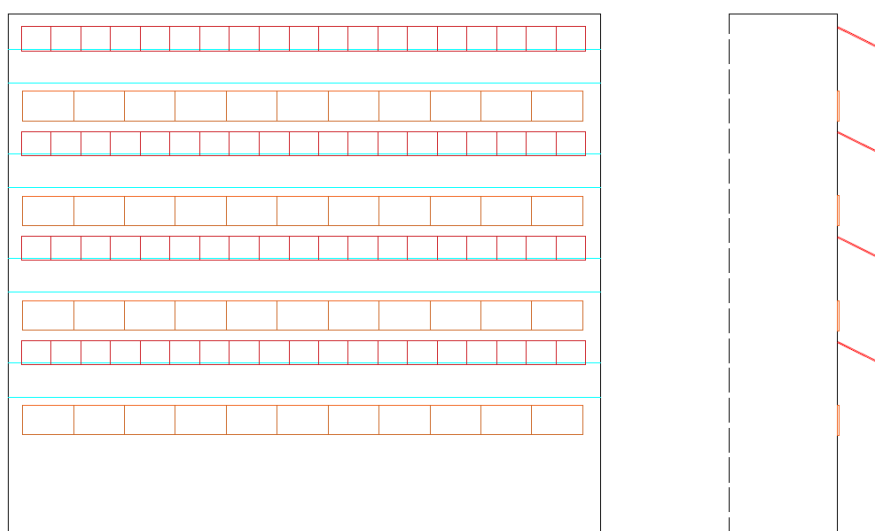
Vista frontal y de perfil de la disposición de los paneles en la fachada suroeste del edificio.
